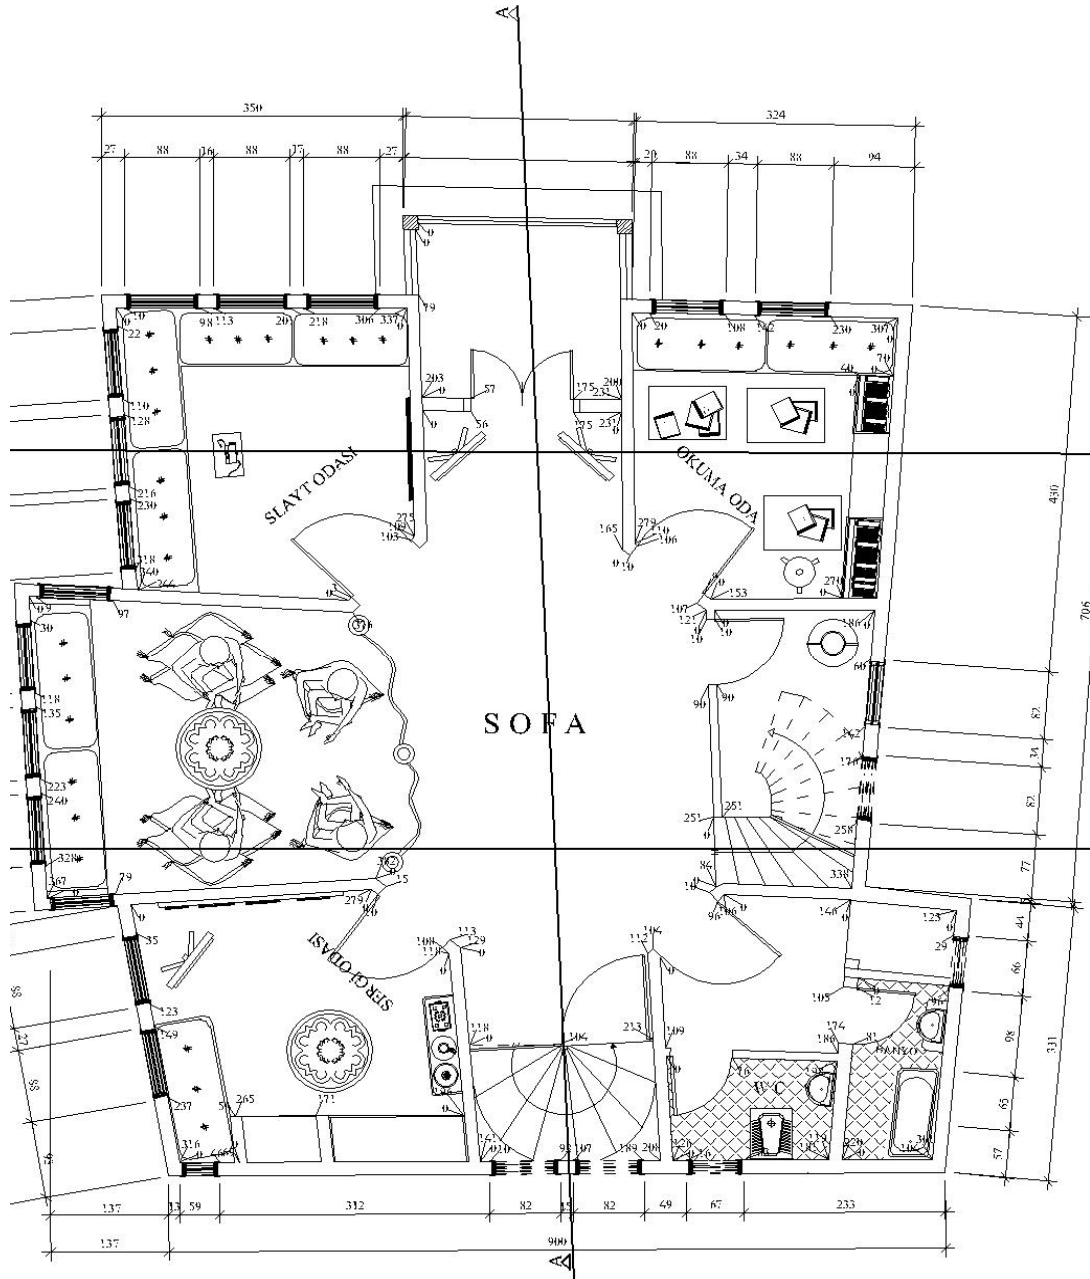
Fenerli Evi'nin plan örneği [1]
